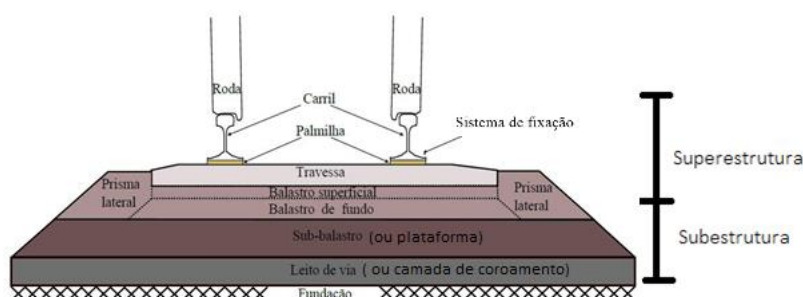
Esquema estrutural da via ferroviária balastrada clássica: secção transversal (adaptado de Vale, 2010).
